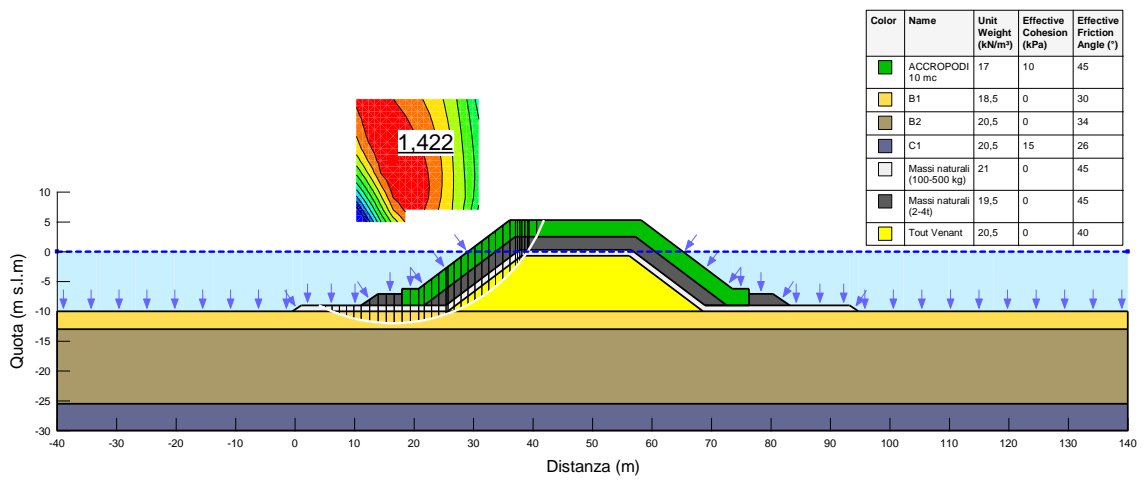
Sezione D – SLV-GEO 1 – Sisma ↑ – Superficie critica sinistra
